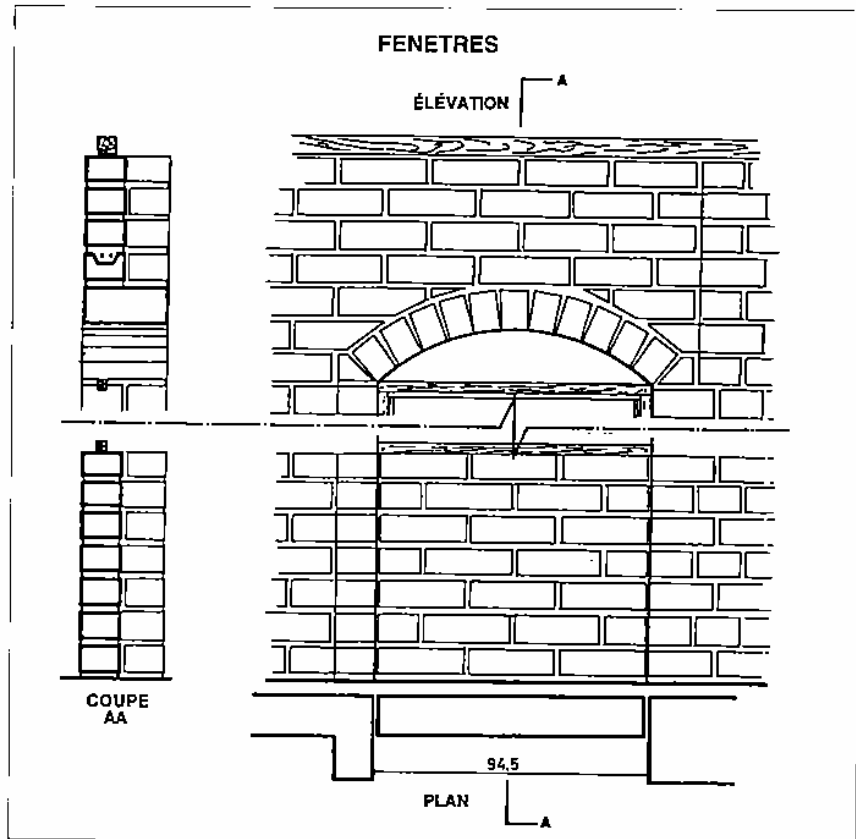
Plan, élévation et coupe verticale sur un tableau de fenêtre à châssis "naco".
